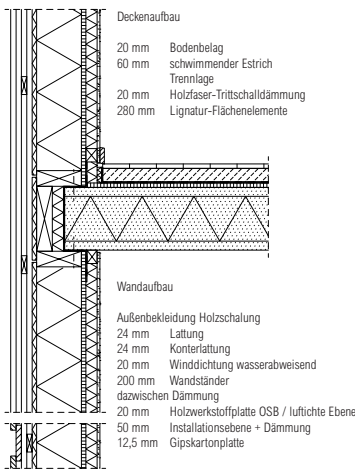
Anschlussdetail Wand - Decke Lignatur
